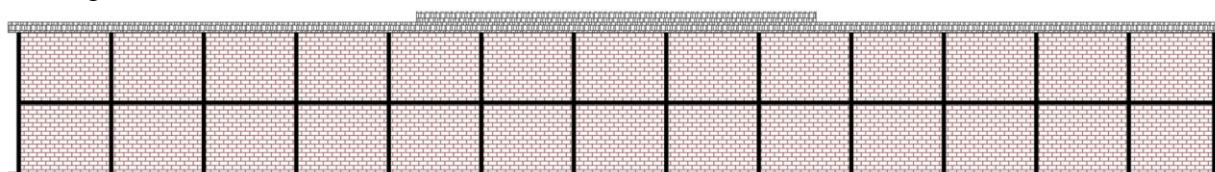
Fachada frontal do Armazém de Armazenamento de Sacarias (sem escala)
